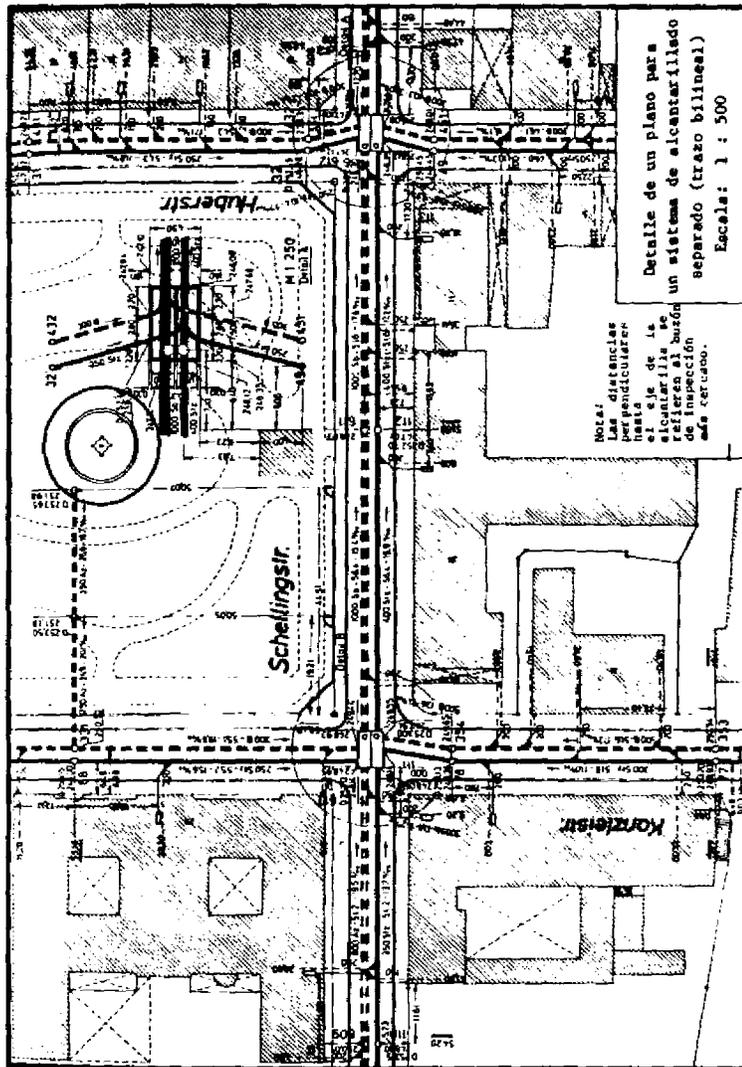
46: Detalle de un plano para un sistema de alcantarillado separado, DIN 2425
